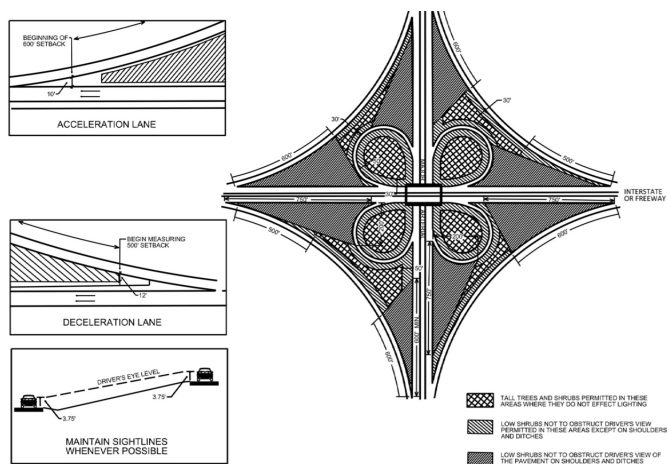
Guia de plantação em interseção do tipo "trevo"¹⁰
